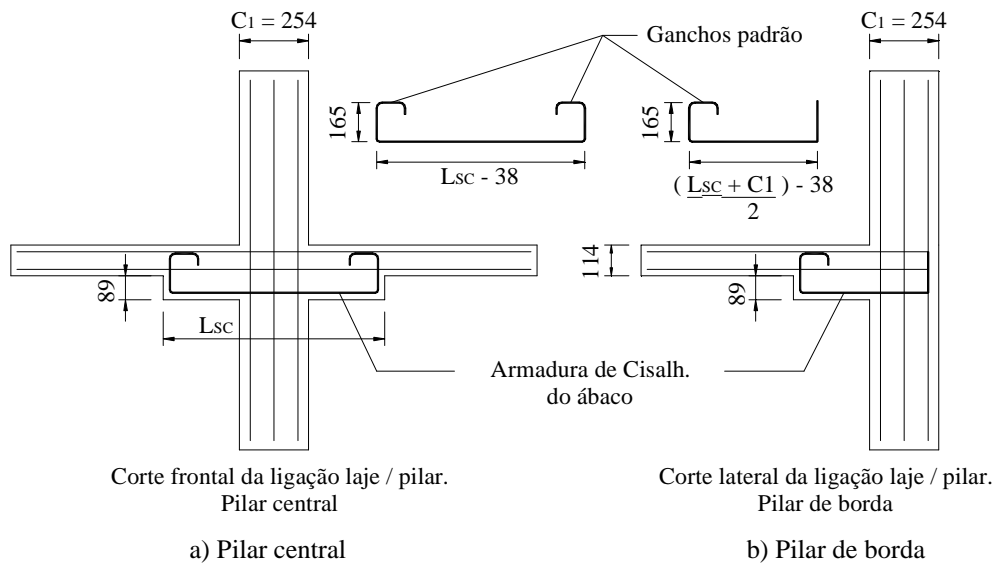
Seção transversal das lajes com pilar central e de borda, mostrando a armadura principal e dos ábacos (WEY, 1991)
